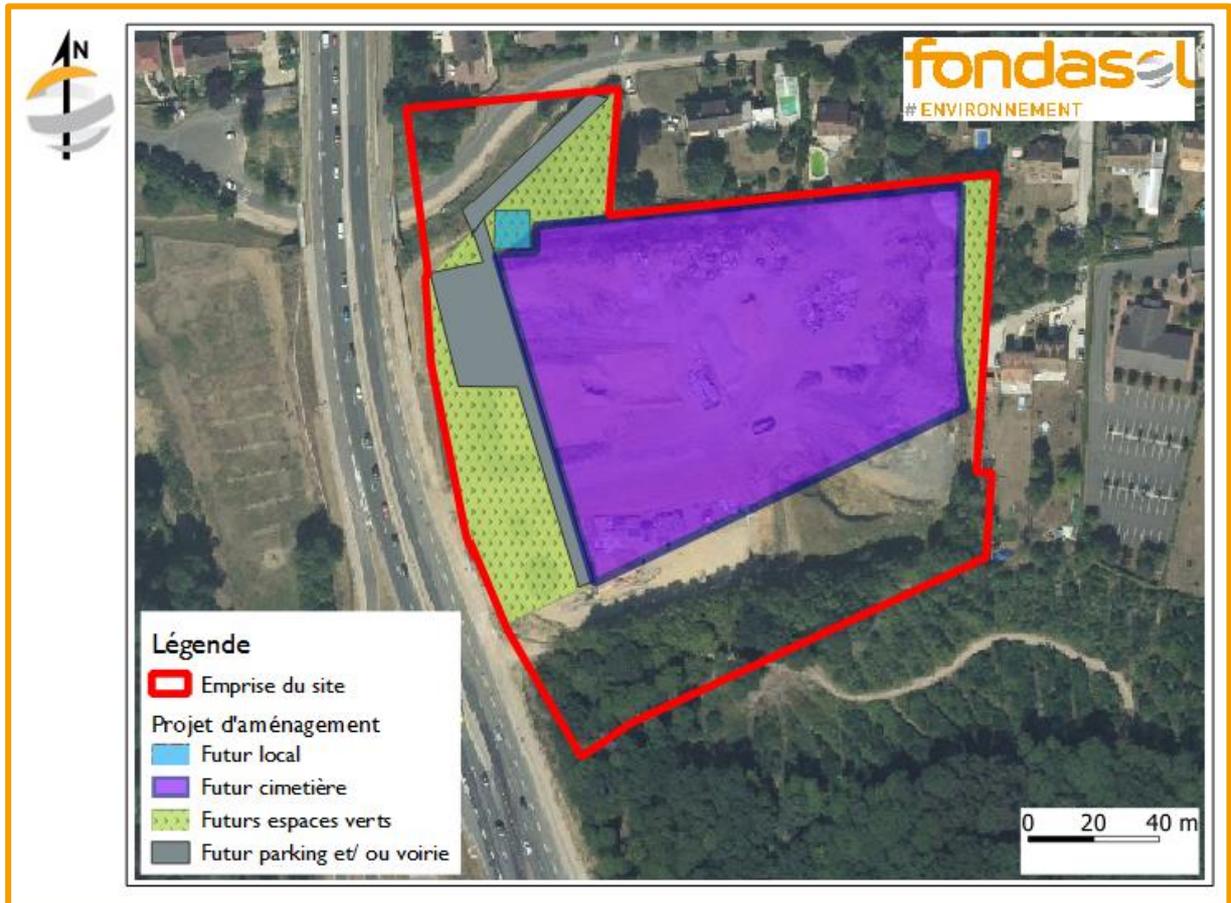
Esquisse du plan de masse du projet d'aménagement (source : Plan de masse transmis le 02/11/2021)
